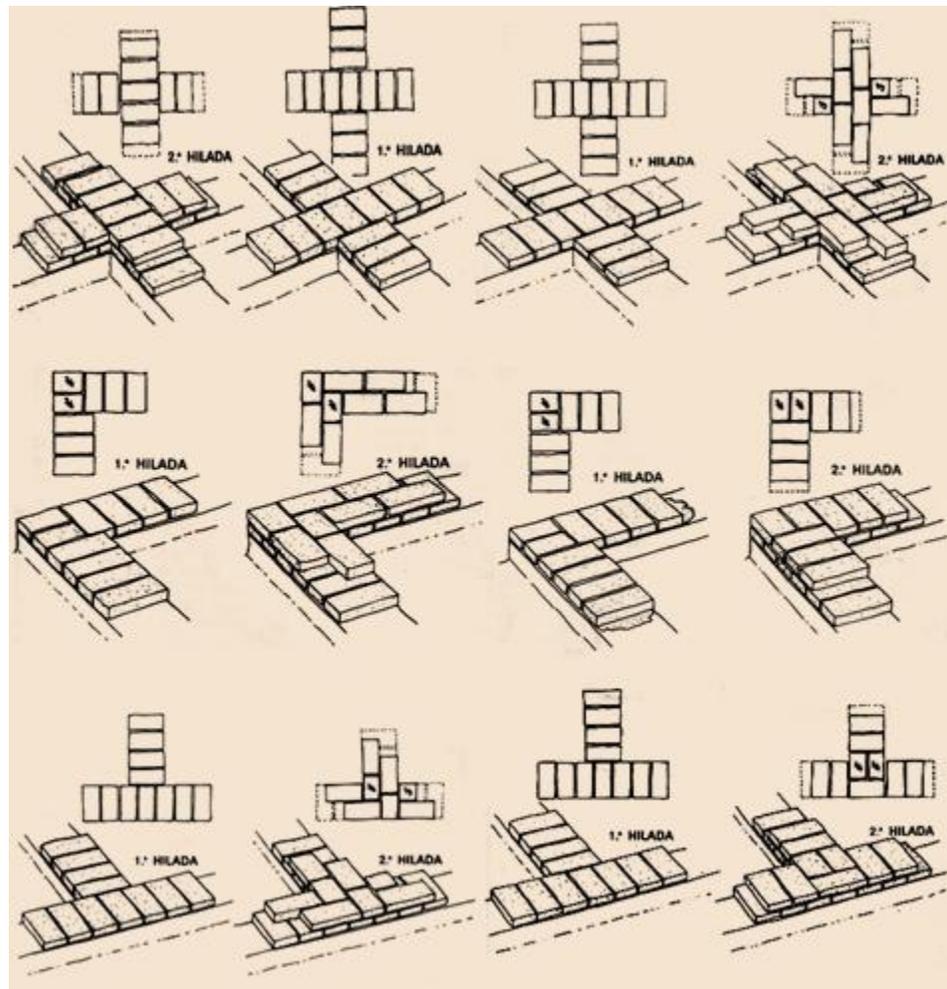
Tipos de colocación de adobe para la construcción de muros.
